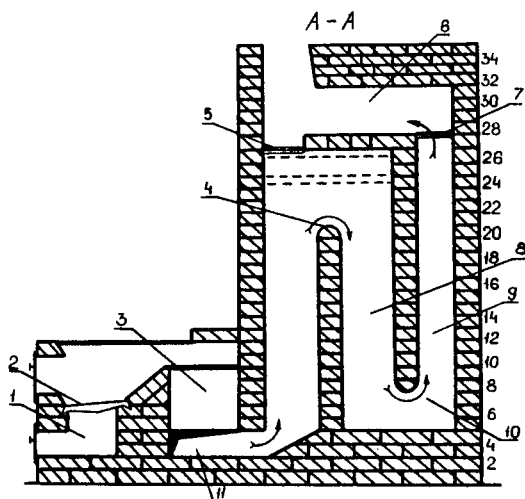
Устройство топливника и дымооборотов в отопительно-варочной печи № 8: 1 — зольник; 2 — колосники; 3 — духовка; 4 — перевал; 5, 7 — летняя и зимняя задвижки; 6 — горизонтальный канал; 8, 9 — дымообороты; 10 — горизонтальный канал; 11 — жаровой канал
